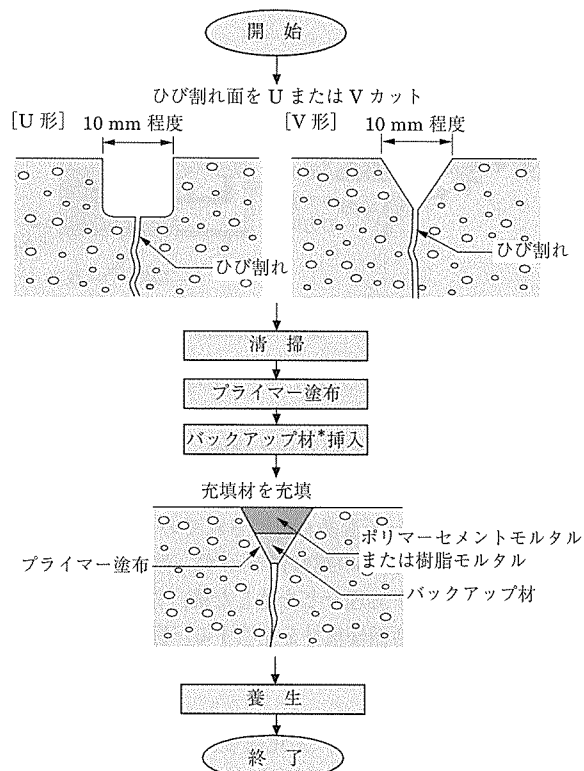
充填工法によるひび割れの補修⁴⁾
